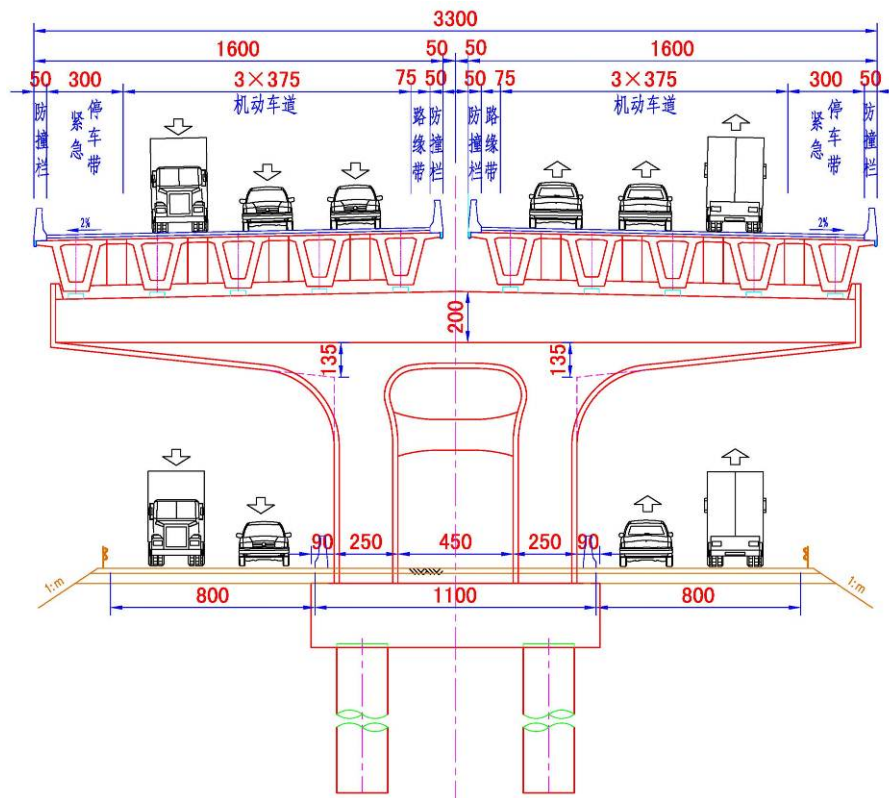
南接线桥梁横断面图 (单位: cm)
